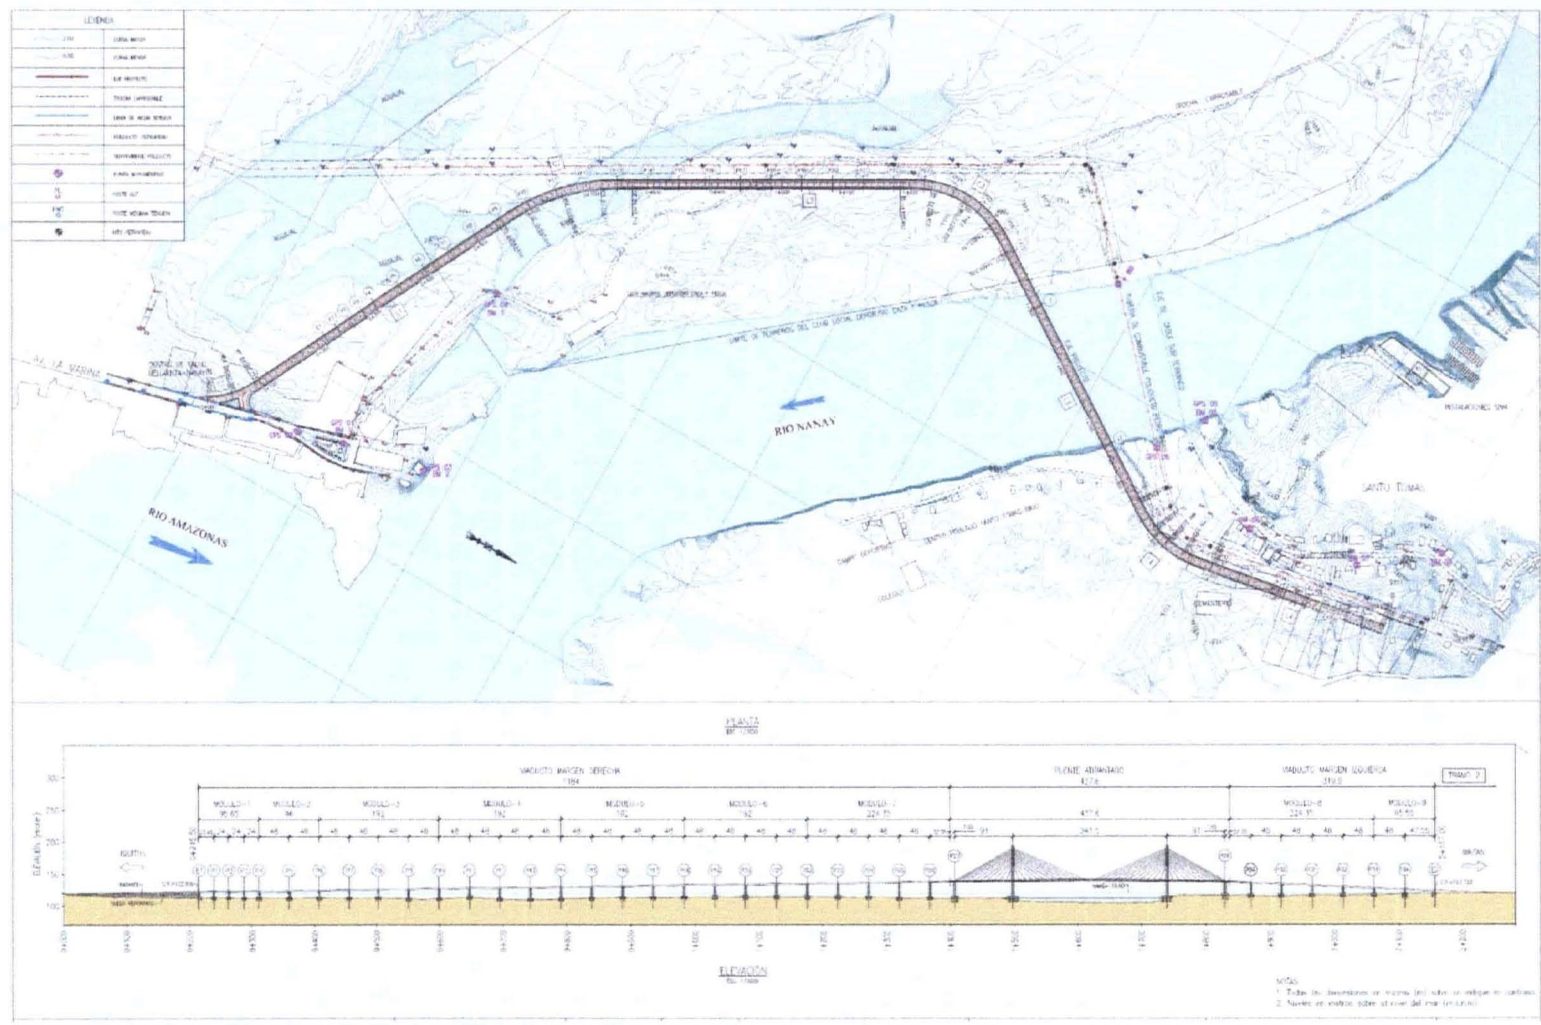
Planta y Elevación del Puente NANAY y Viaductos de Acceso
